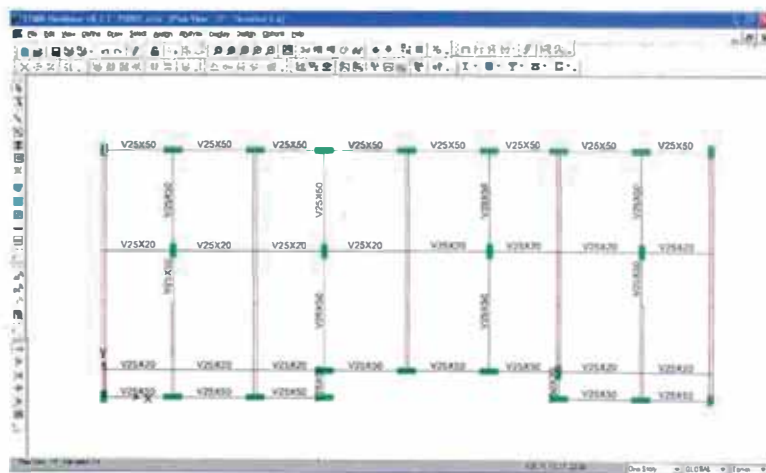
Planta típica de la edificación de 5 niveles - Modelo Etabs
